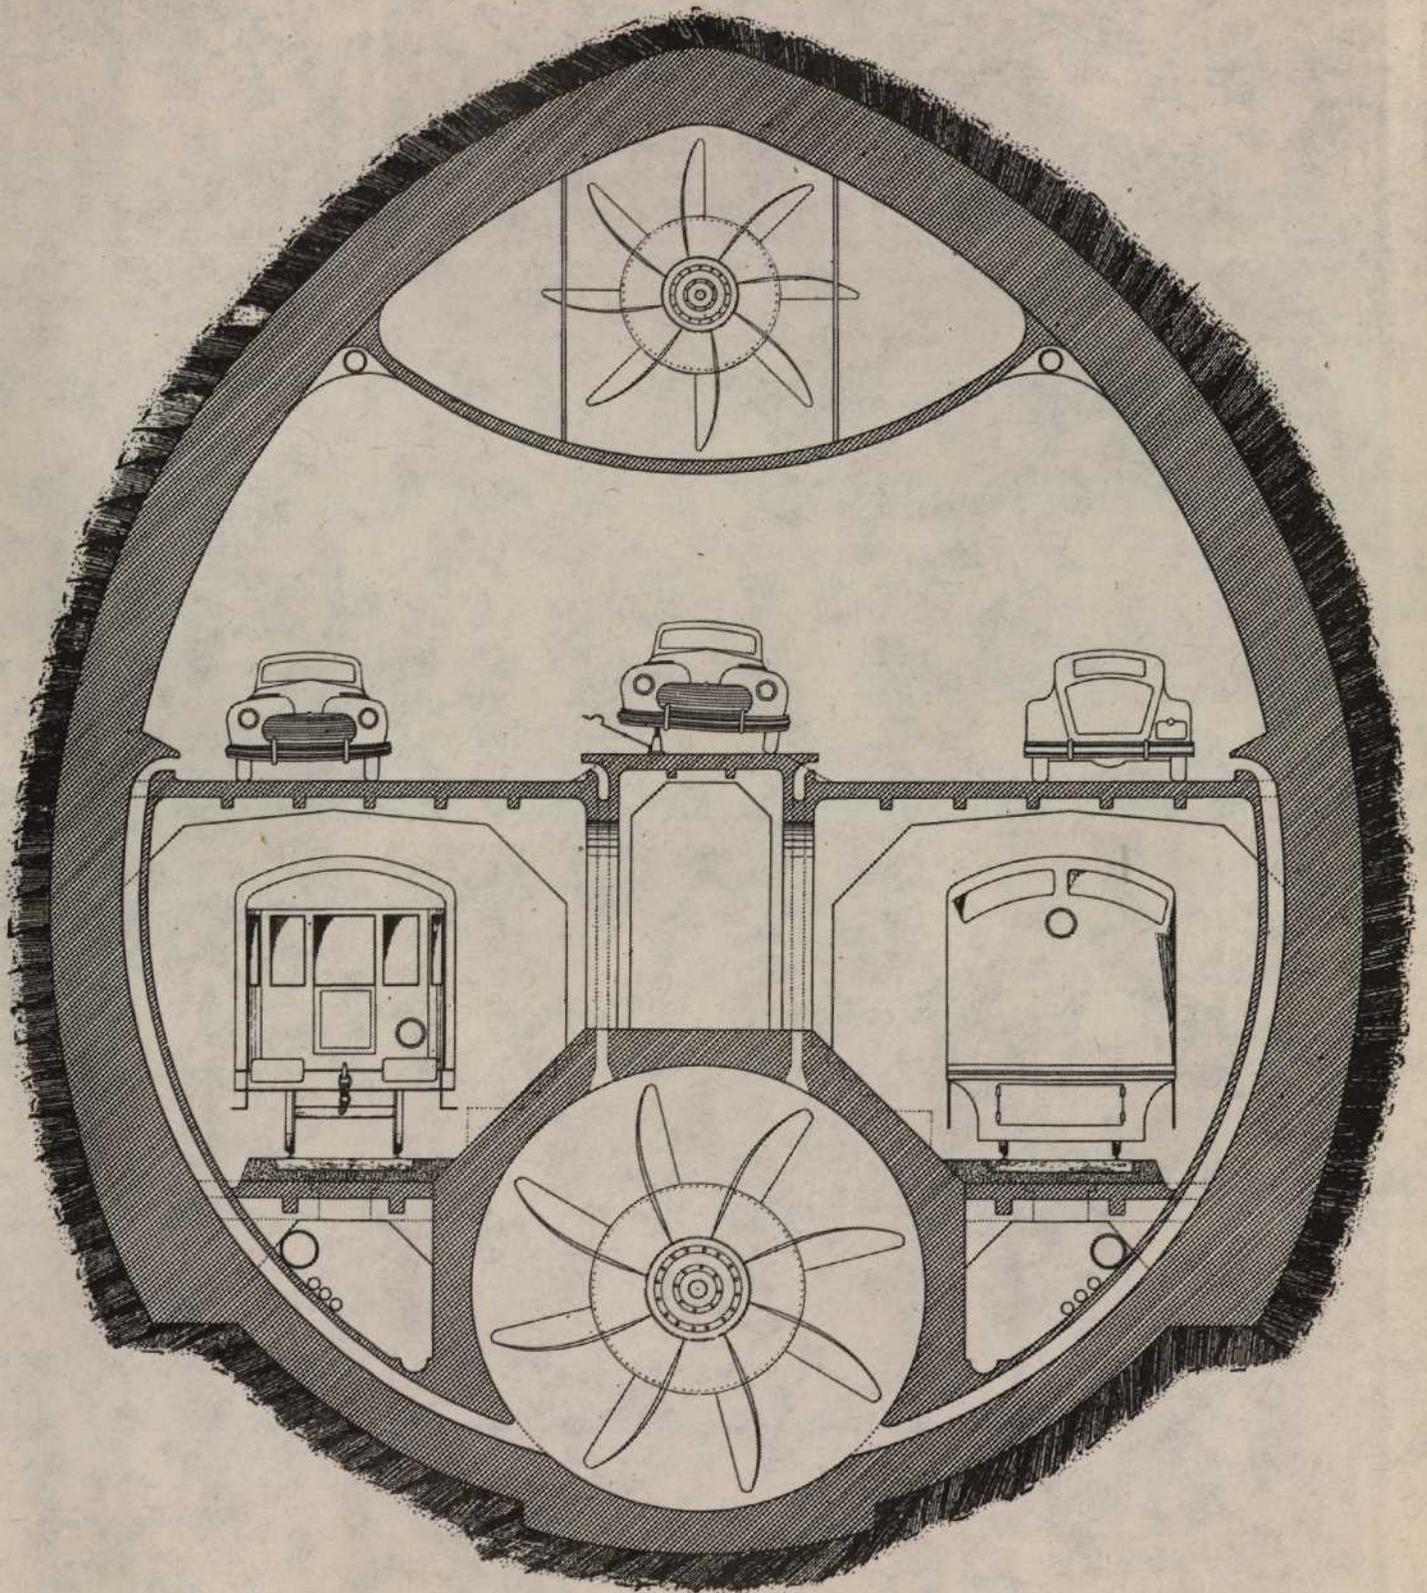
Coupe du tunnel mixte Basdevant 1948
